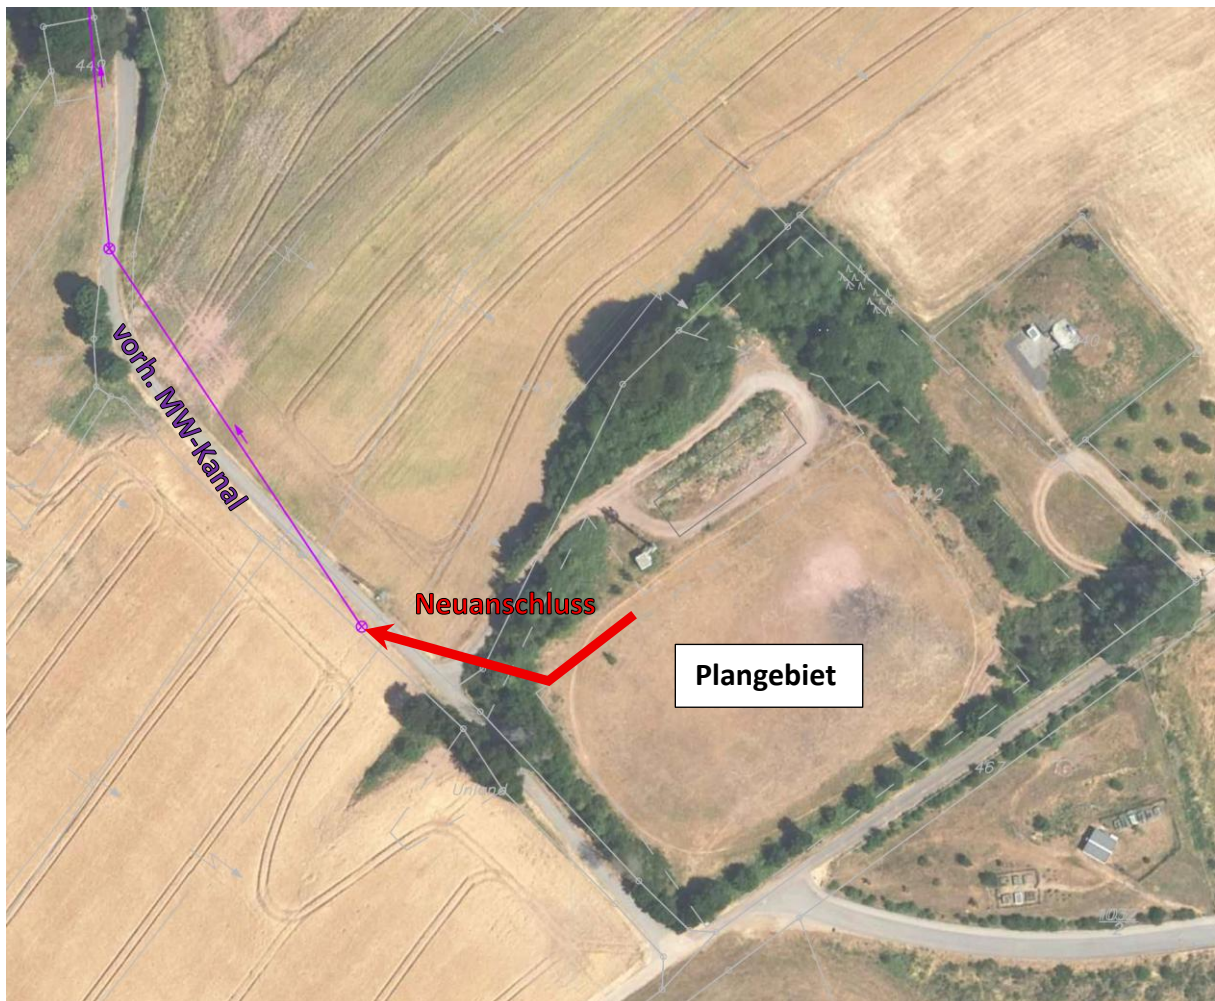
Darstellung des Plangebiets mit bestehendem MW-Kanal
